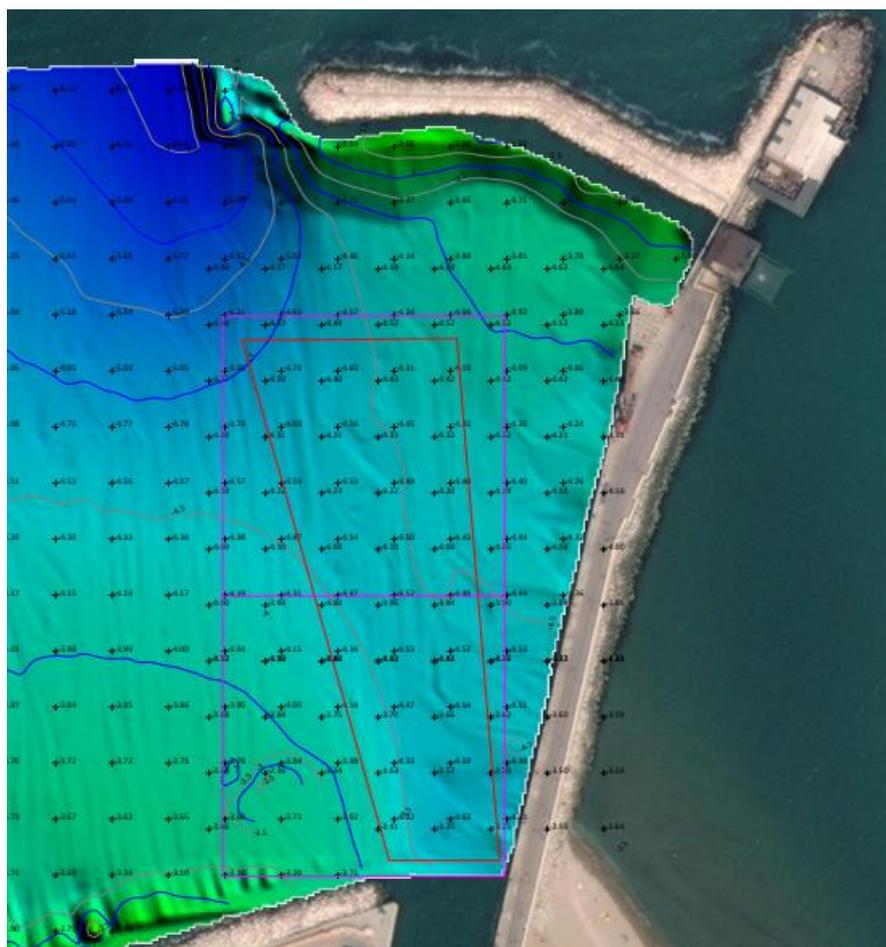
Planimetria con ubicazione aree di caratterizzazione(viola) e perimetro area dragaggio(rosso)
